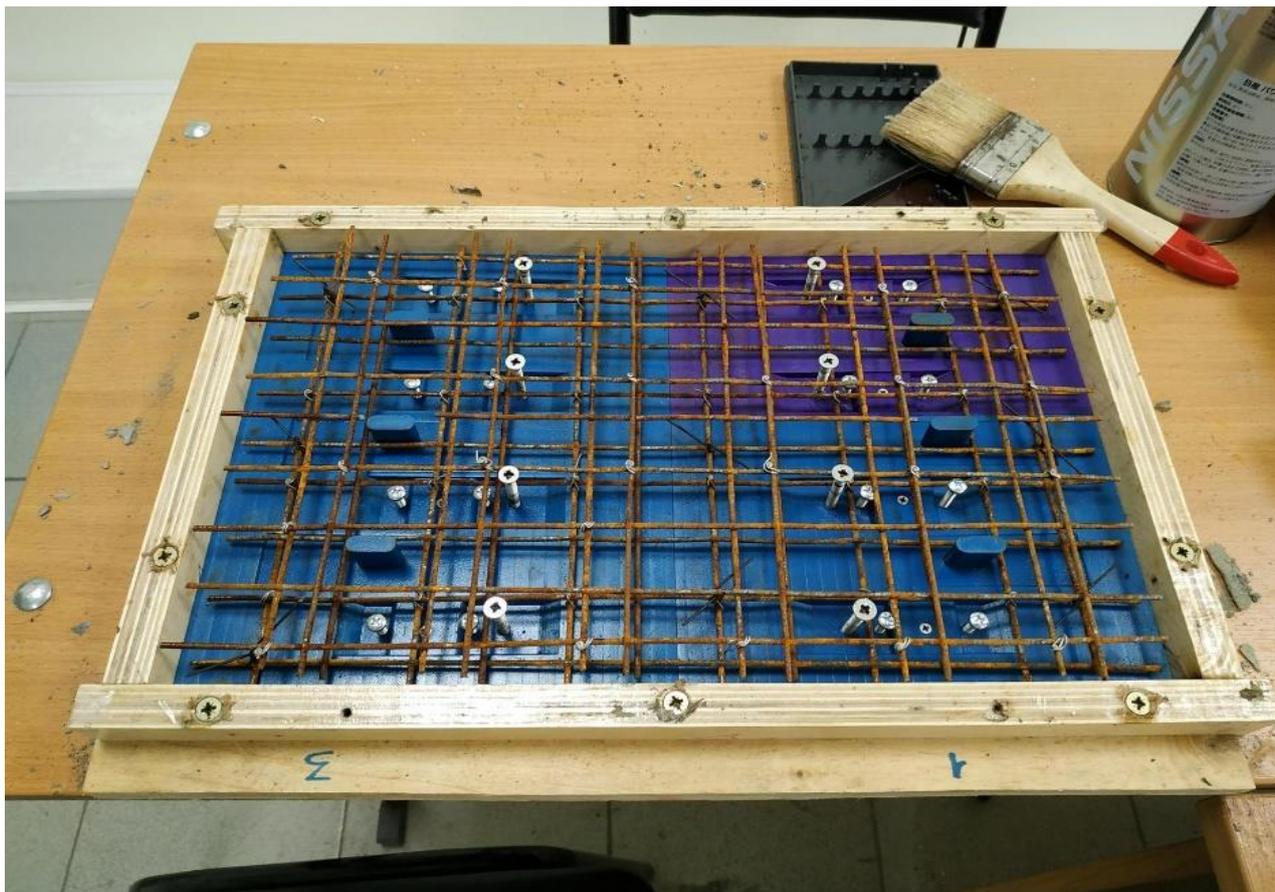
Опалубка для бетонирования плиты безбалластного мостового полотна
